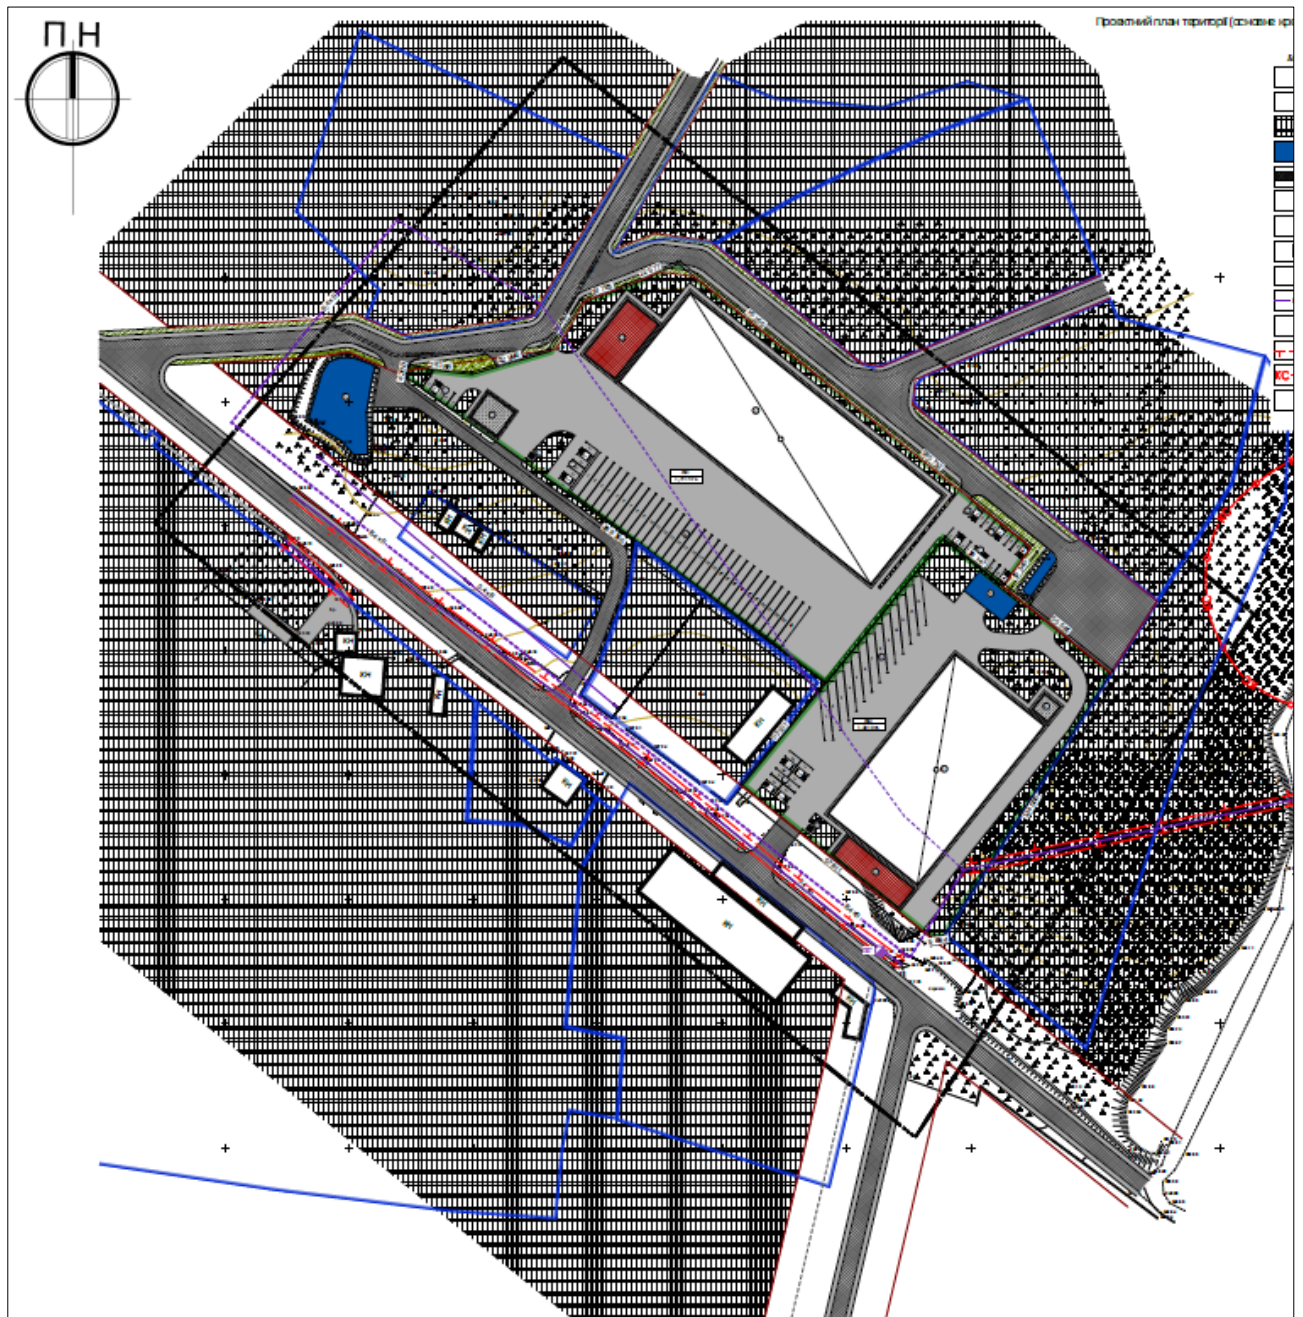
Проектний план території (основне креслення) та планувальні обмеження
